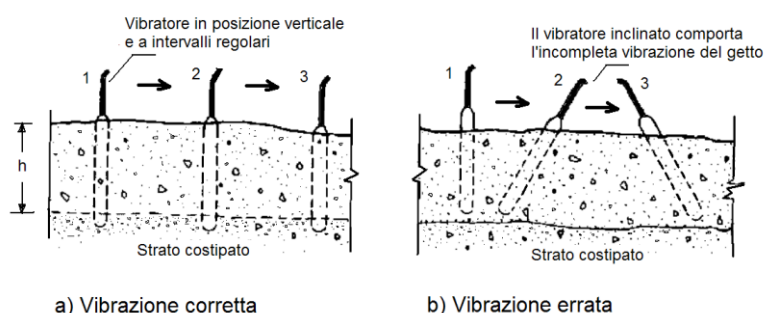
Esecuzione del getto e modalità di costipazione mediante vibrazione interna
